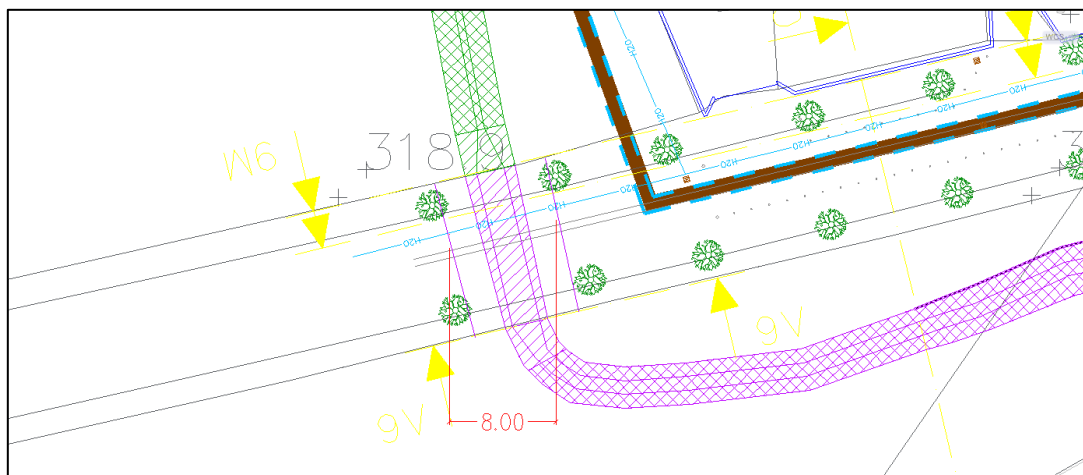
Interferenze area 1 – stralcio planimetrico
